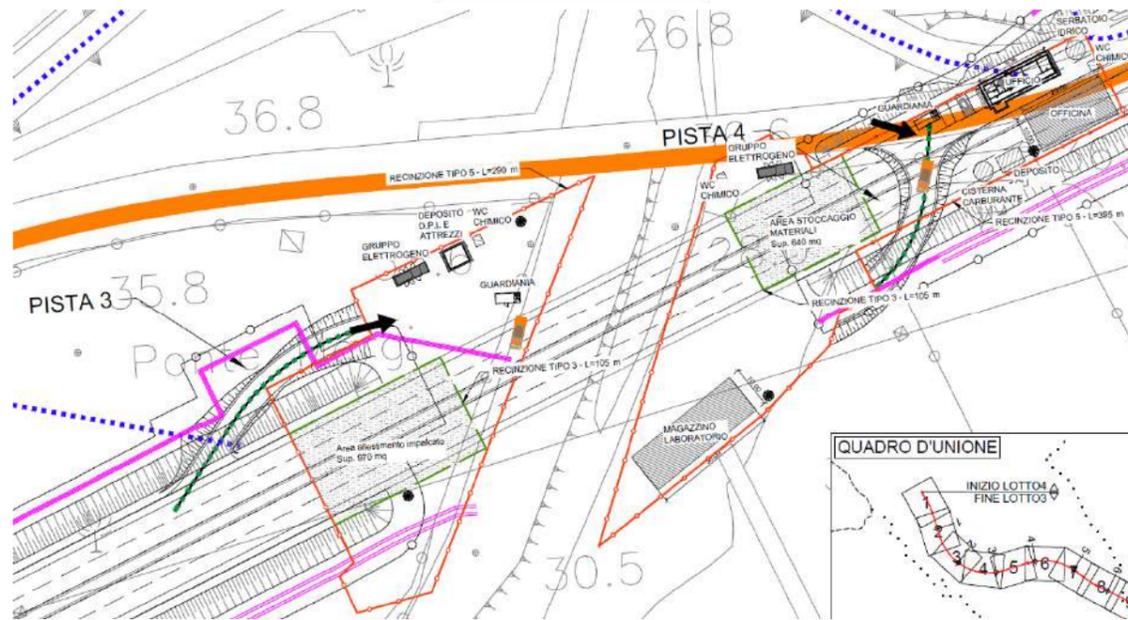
Planimetria del cantiere operativo CA.V.17.
